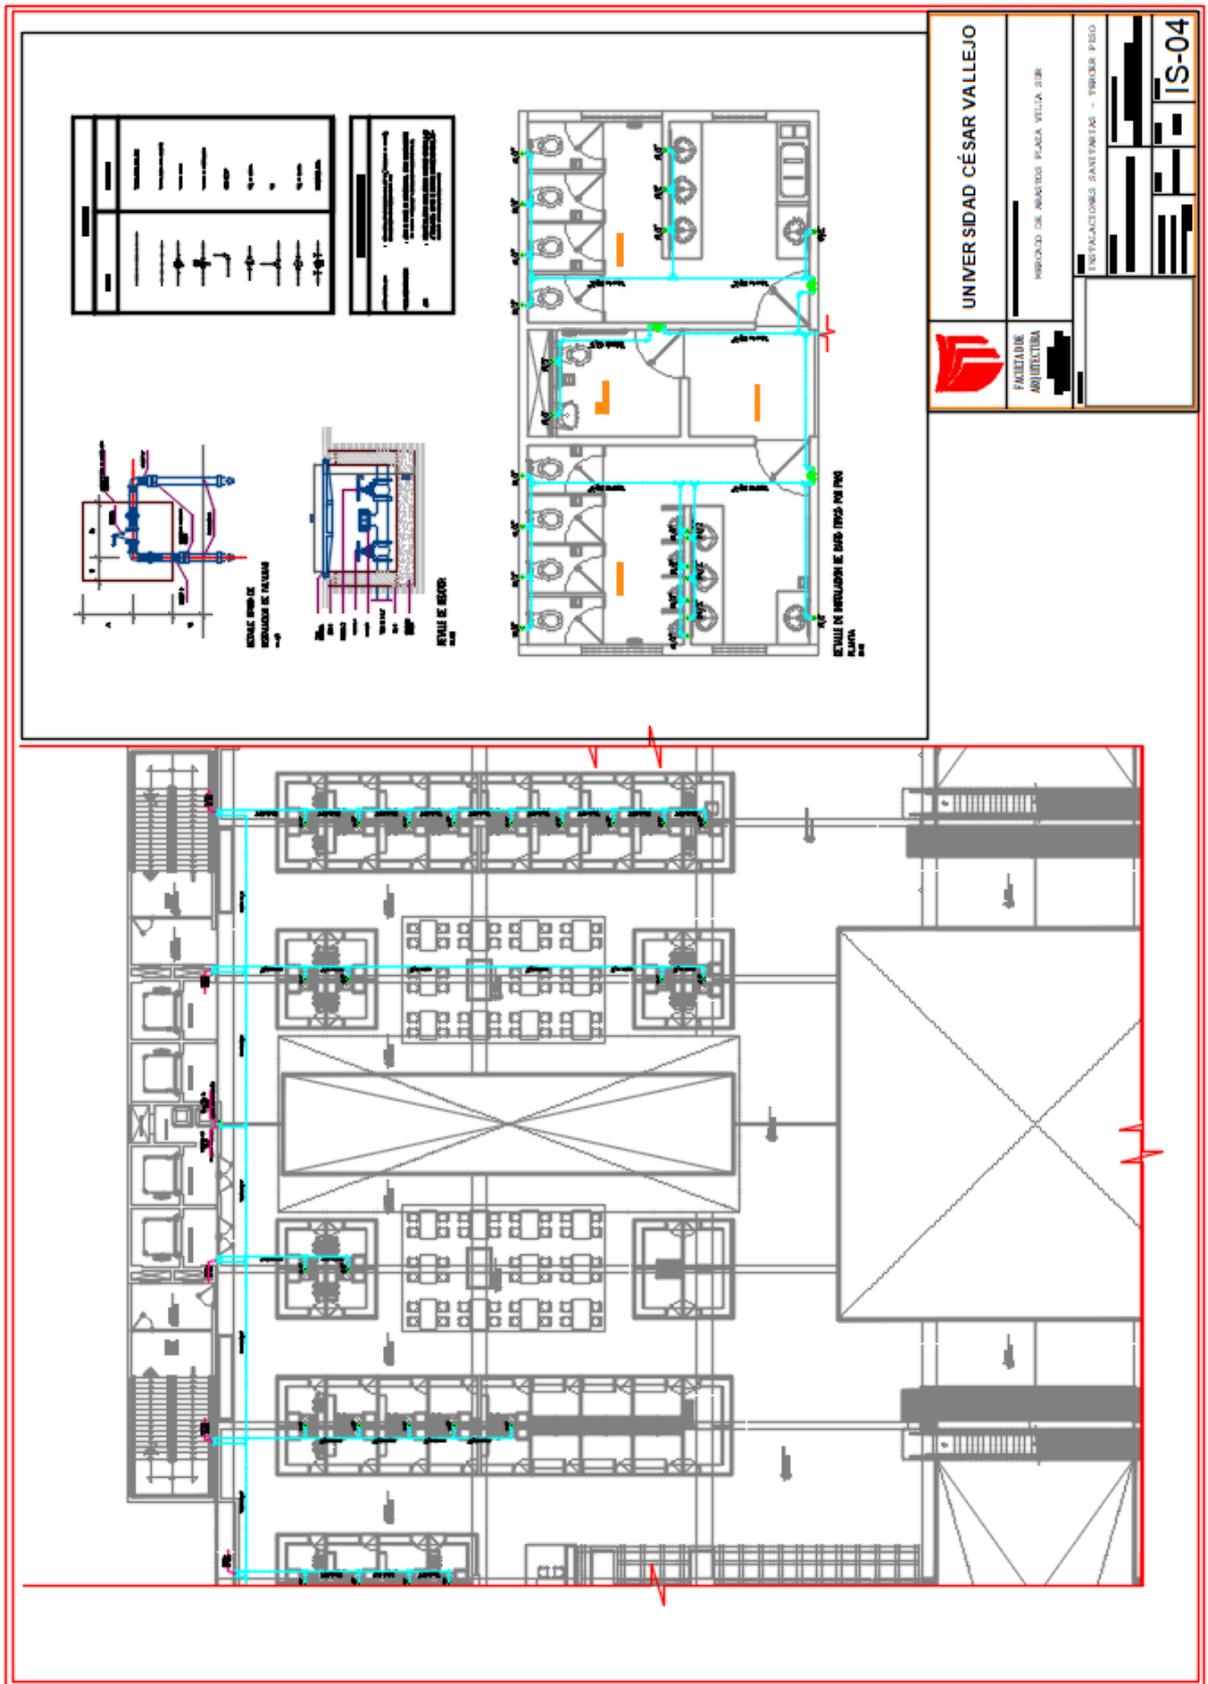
Plano de Sanitarias – Plano de instalaciones de Agua – tercer piso.
